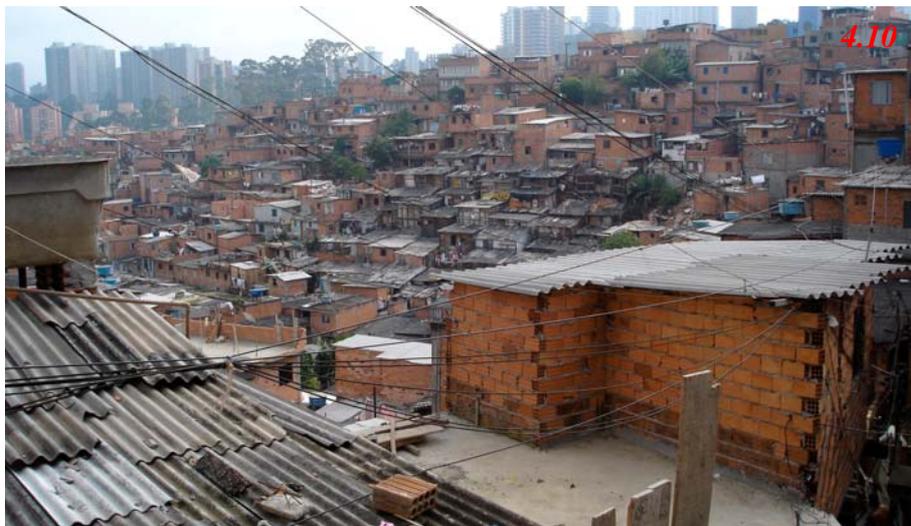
Ocupação populacional com construções em alvenaria e em madeira
